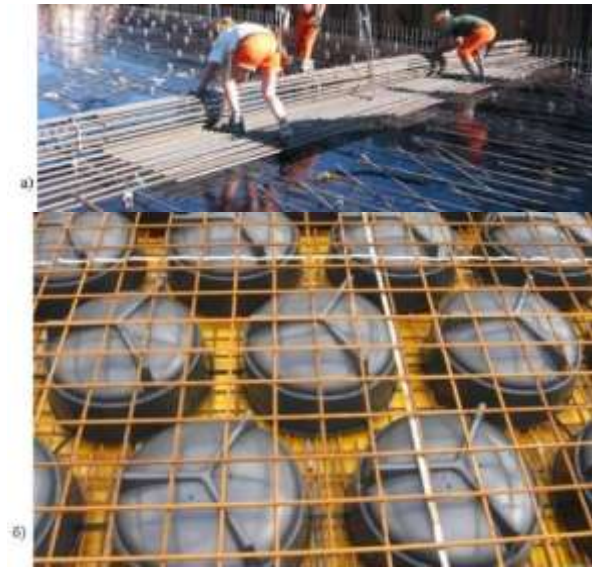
Устройство облегченных железобетонных перекрытий по технологии Veerplate: а) раскладка нижней арматурной сетки; б) расстановка вкладышей
